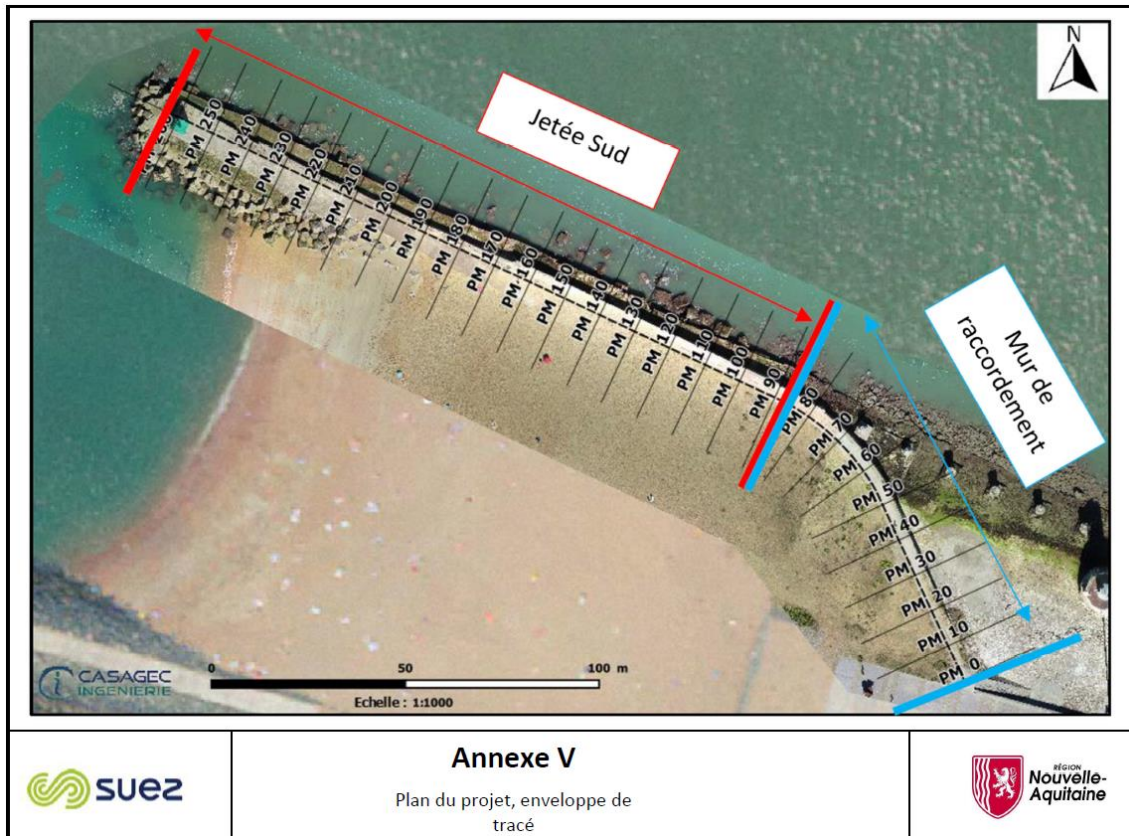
Plan du projet et enveloppe de tracé – Source : SUEZ Consulting, CASAGEC INGENIERIE
